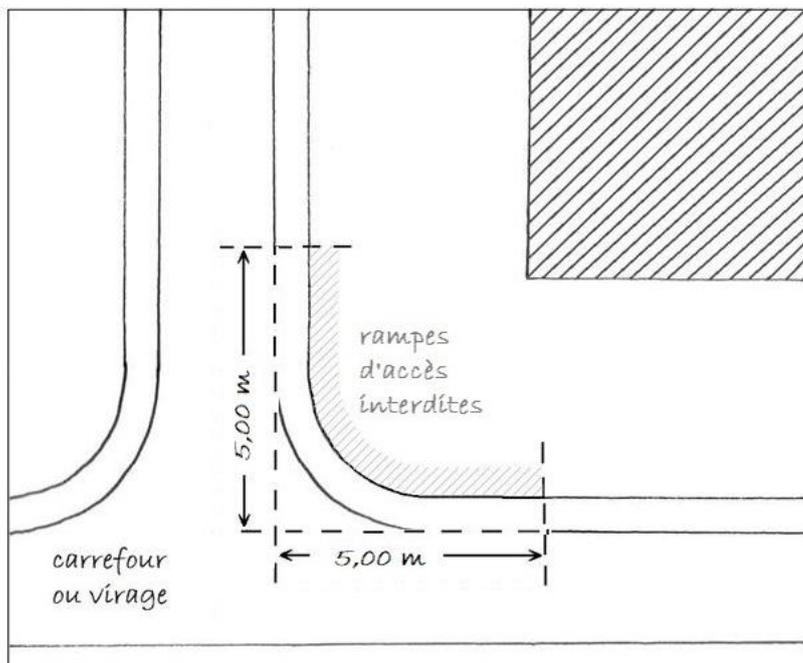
Rampes d'accès à proximité d'un carrefour ou d'un virage
